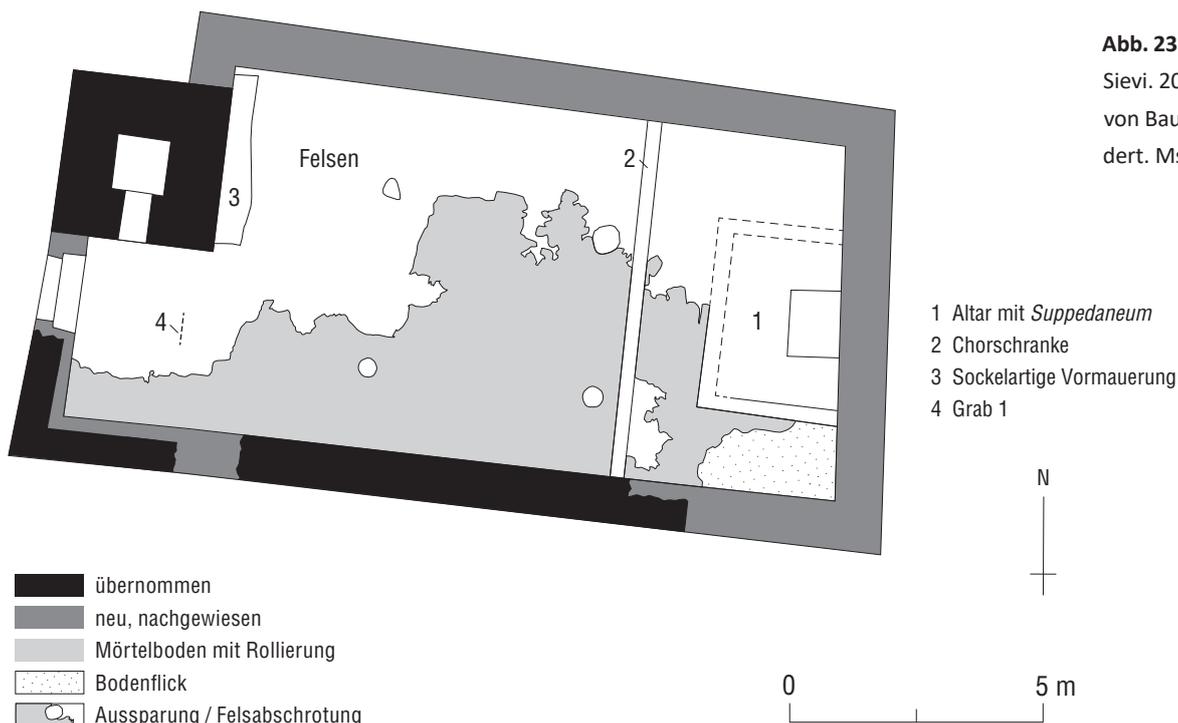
Breil/Brigels, Sogn Sievi. 2018/20. Grundriss von Bau II, 12./13. Jahrhundert. Mst. 1:150.
